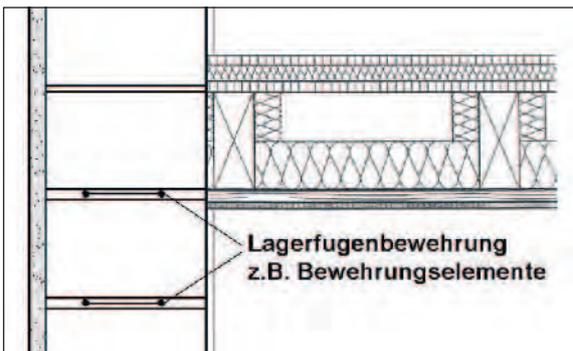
Ringanker als bewehrtes Mauerwerk;
